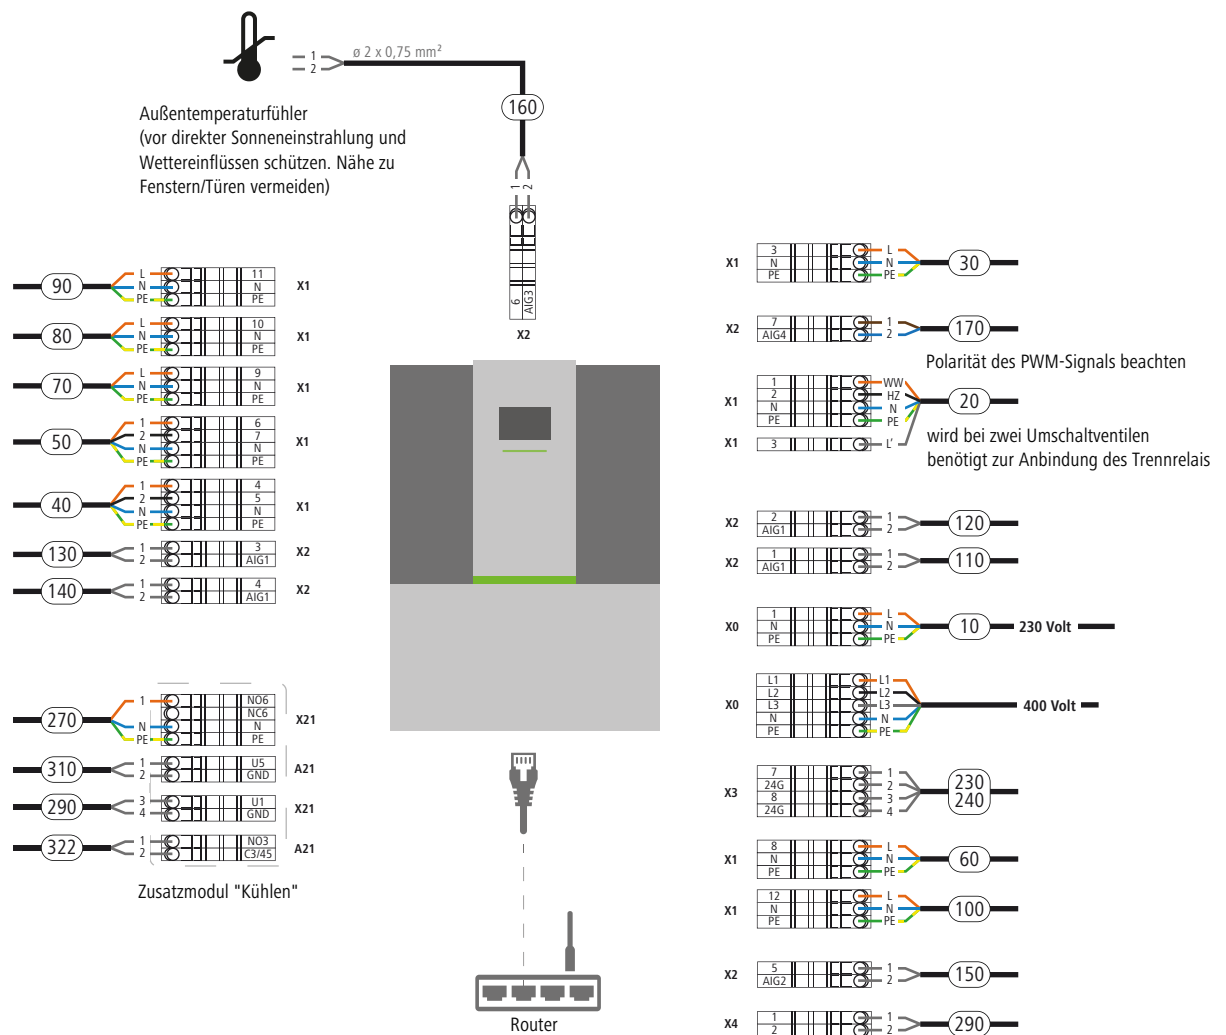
Elektroinstallationsplan mit Speicherkombination
